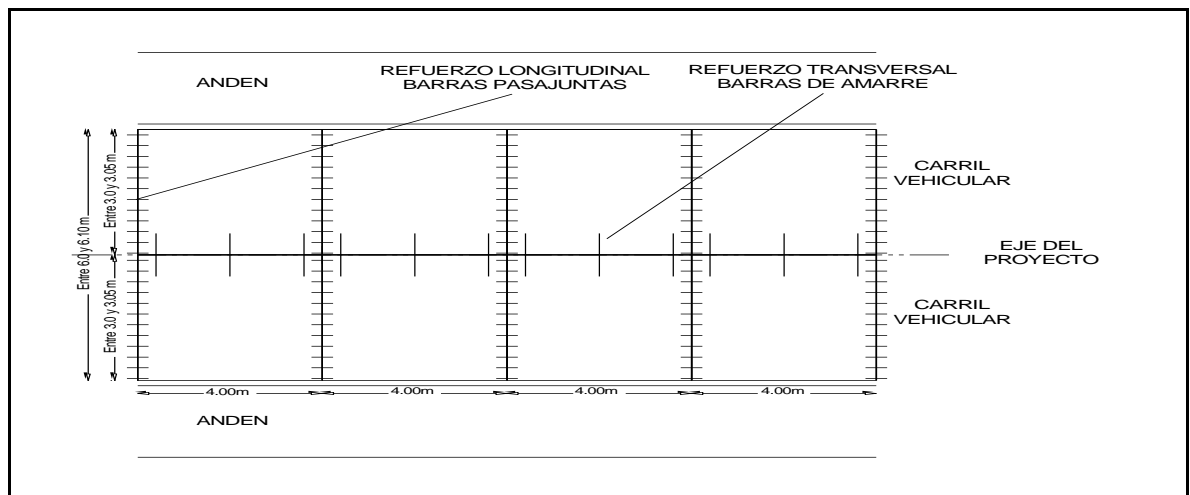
Detalle Colocación de pasa-juntas y barras de amarre.
